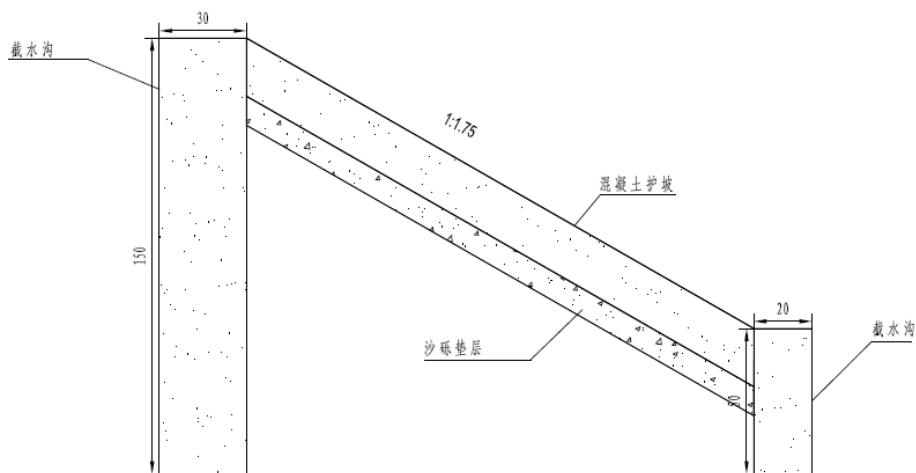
混凝土护坡典型设计图（单位：cm）
